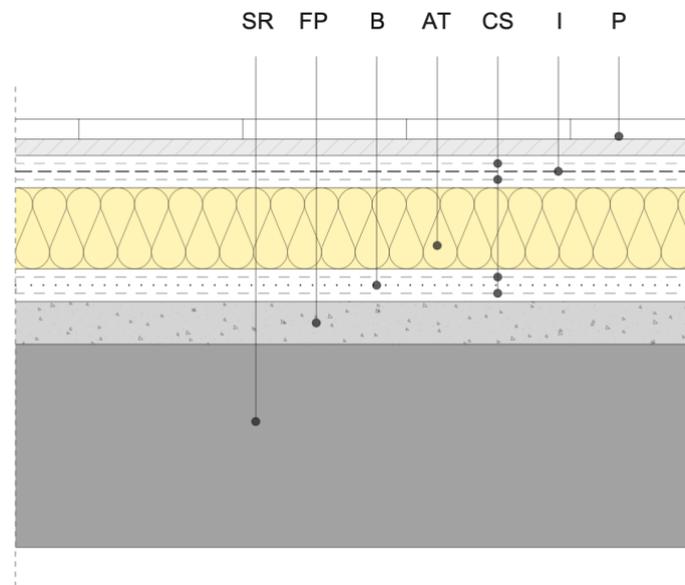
Cubierta convencional. Leyenda: SR Soporte resistente. FP Formación de pendiente. B Barrera cortavapor. AT Aislante térmico. CS Capa separadora. I Impermeabilización. P Protección.
